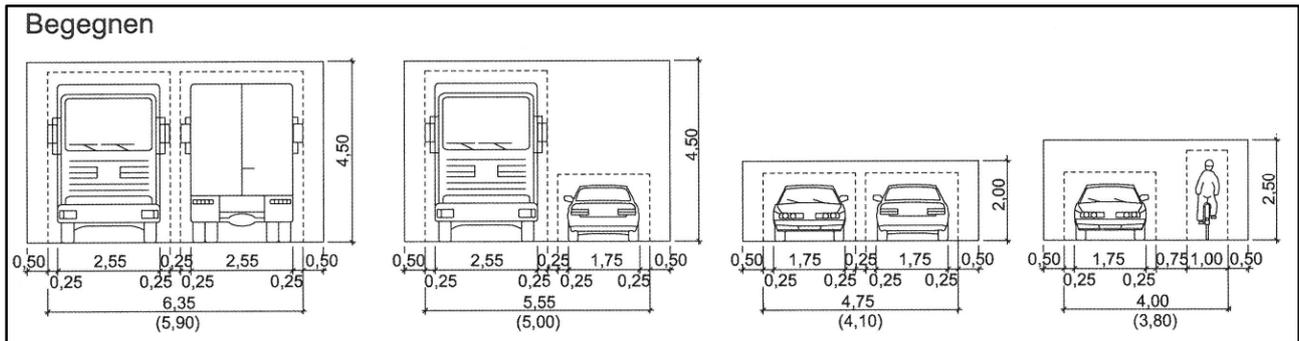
Auszug Bild 17 RAST „Verkehrsraum und lichter Raum beim Begegnen (Klammermaße: mit eingeschränkten Bewegungsspielräumen)
